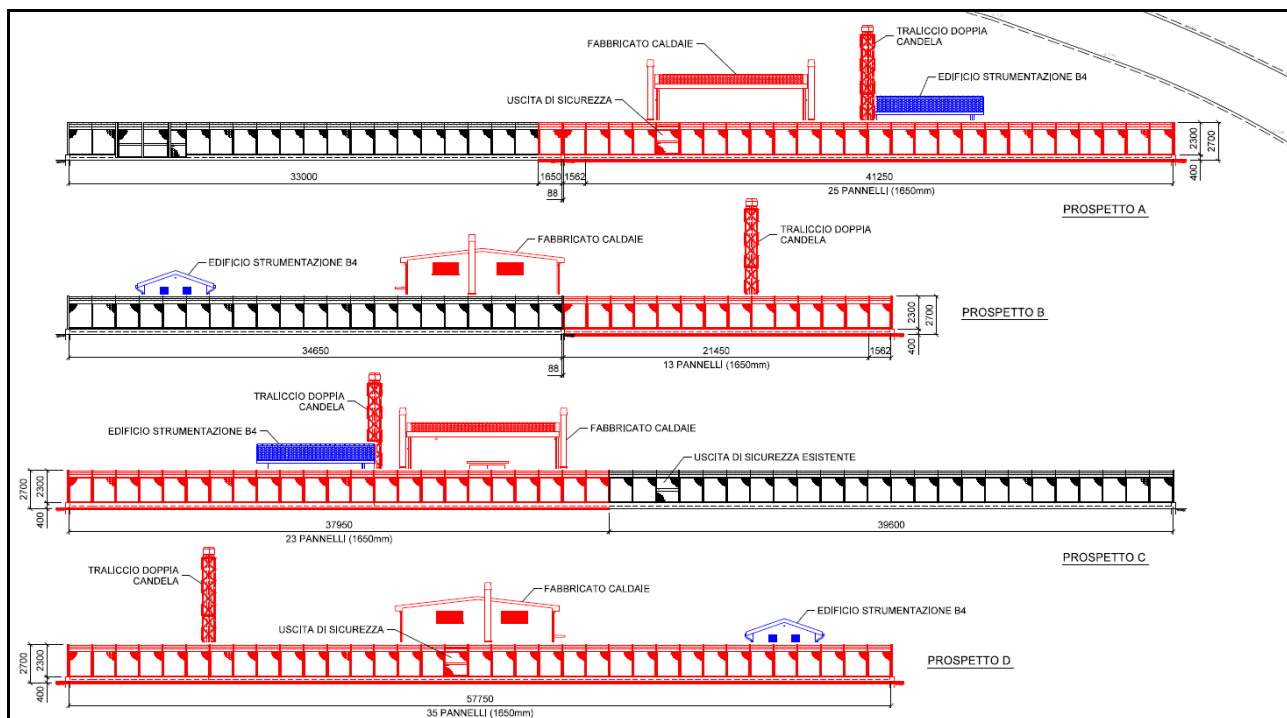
Elaborato planimetrico non in scala con individuazione dei prospetti del nuovo impianto
